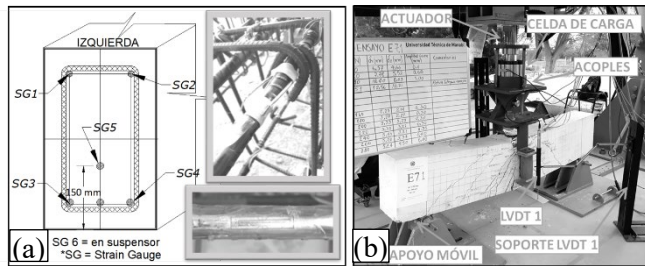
Detalles de instrumentación y toma de datos (a) Instrumentación interna. (b) Vista general de la instrumentación externa.
